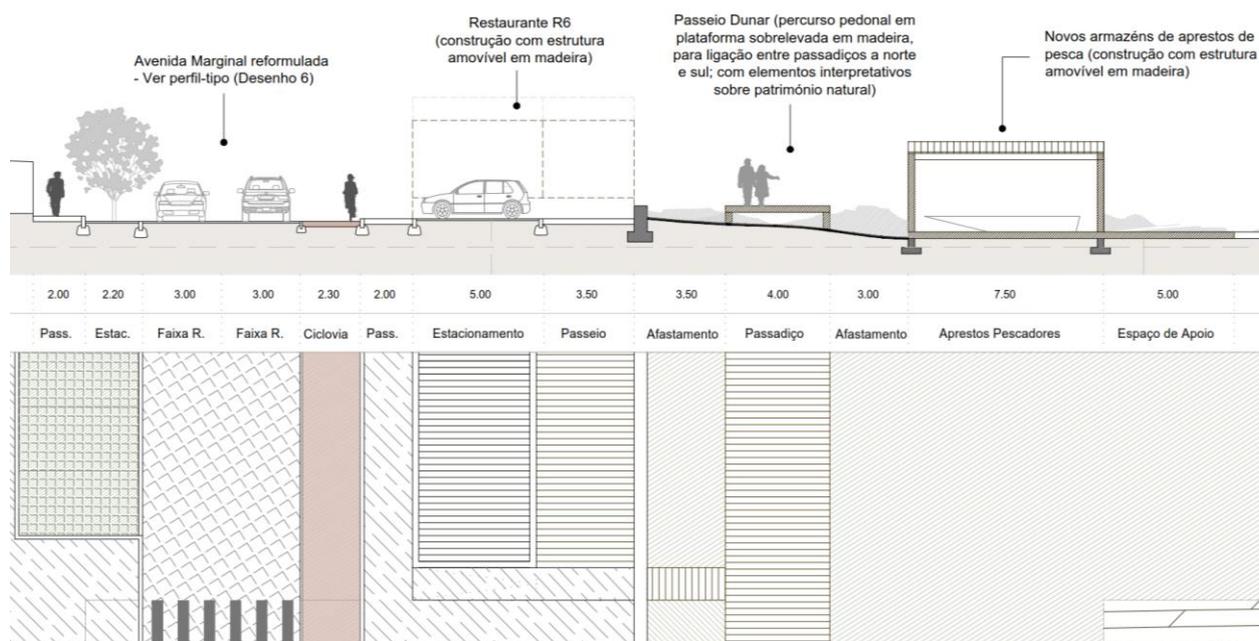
Plano Geral – Perfil Transversal na zona urbana consolidada
